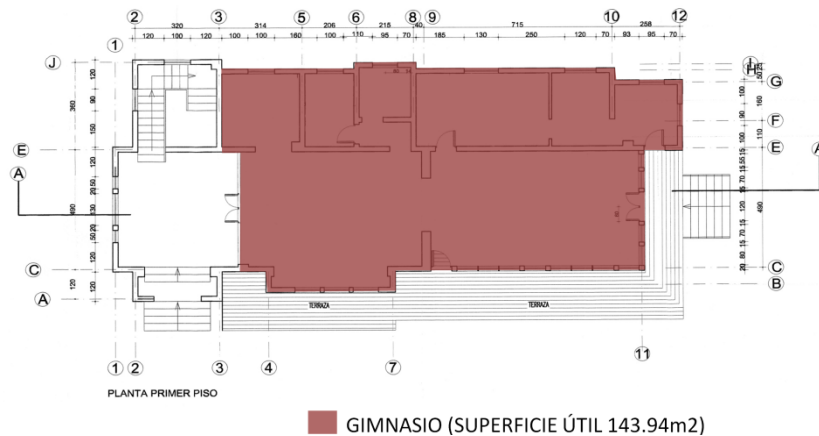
Planta de Primer Piso Casona Ex Sporting
